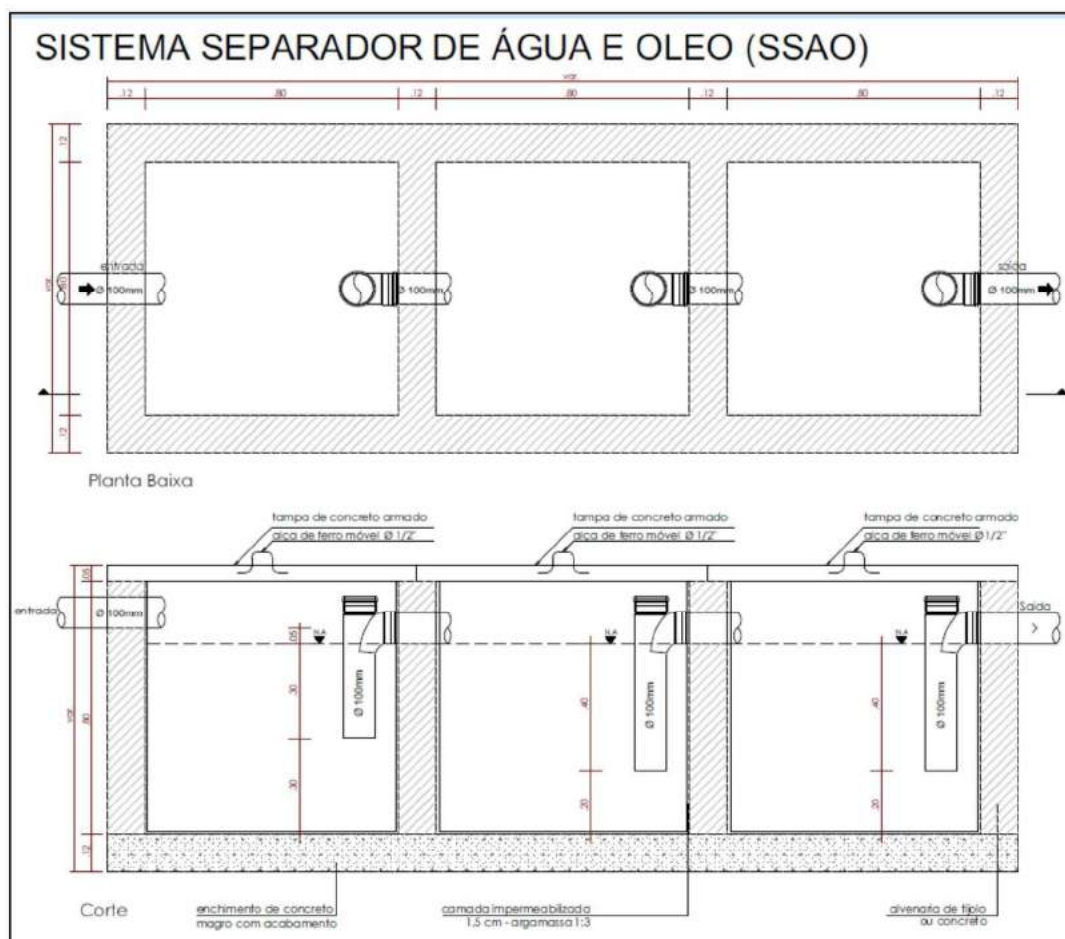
Detalhes do SSAO. Fonte Projeto Hidrossanitário.
